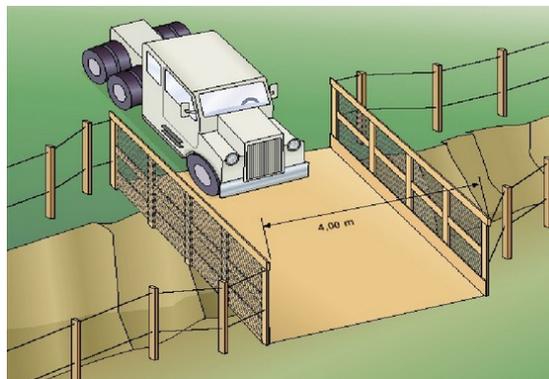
Tráfego de veículos sobre escavação (Escavações, Fundações e Desmorte de Rochas, 2002)
